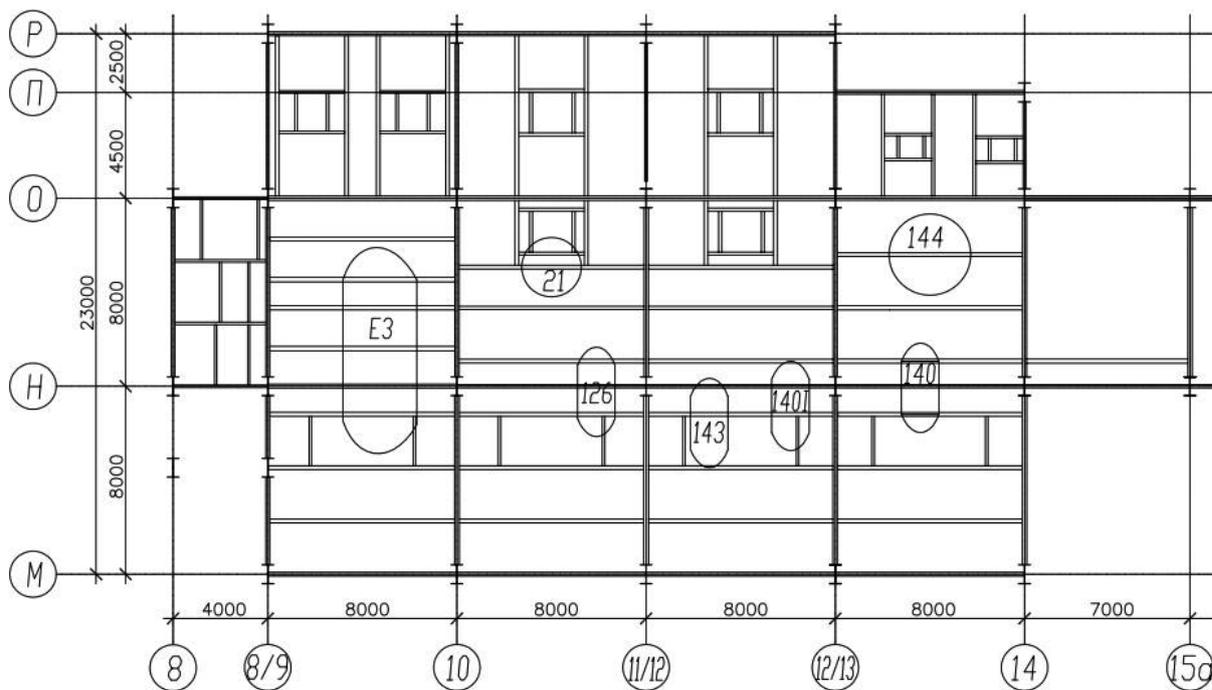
План этажерки Д-5 на отметке 4,8 м с расположением оборудования
